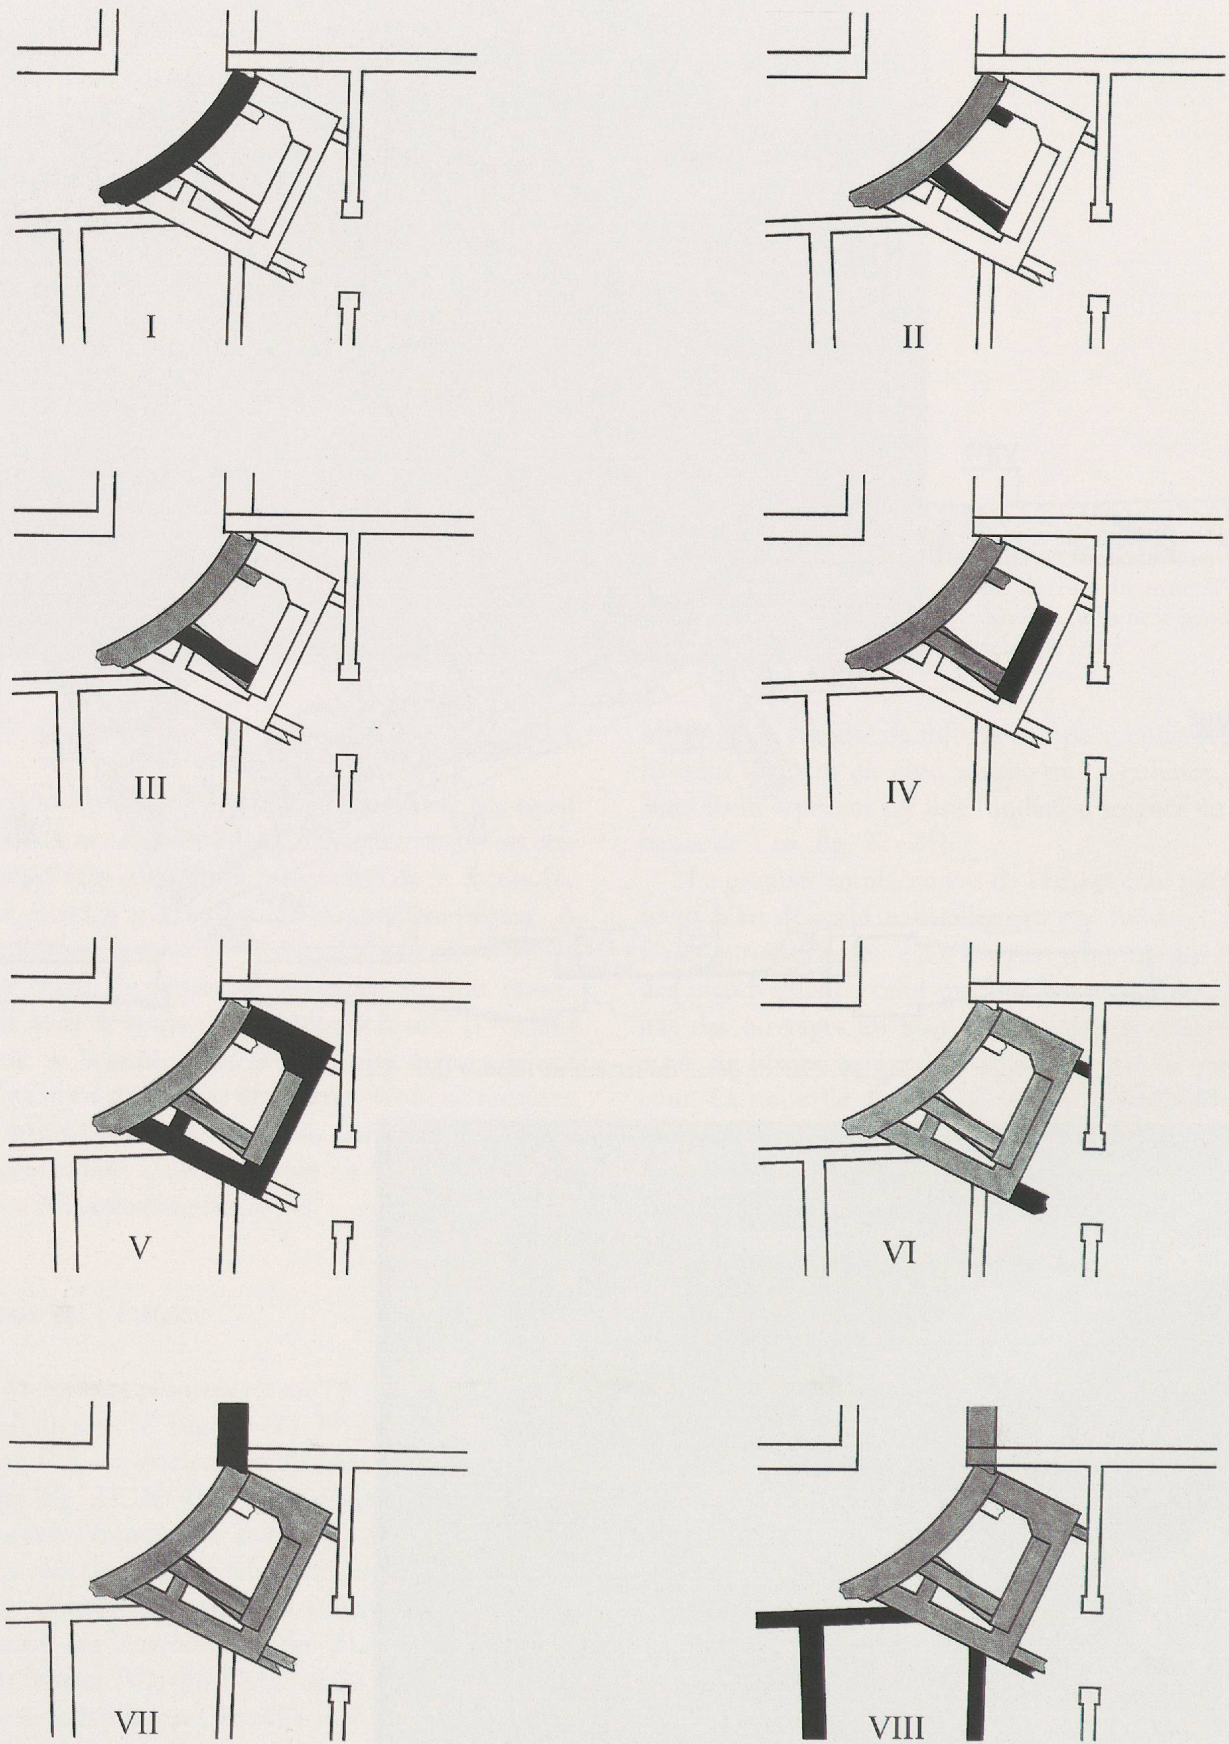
Plan des étapes de construction dans le secteur de l'entrée (éch. 1:400).
